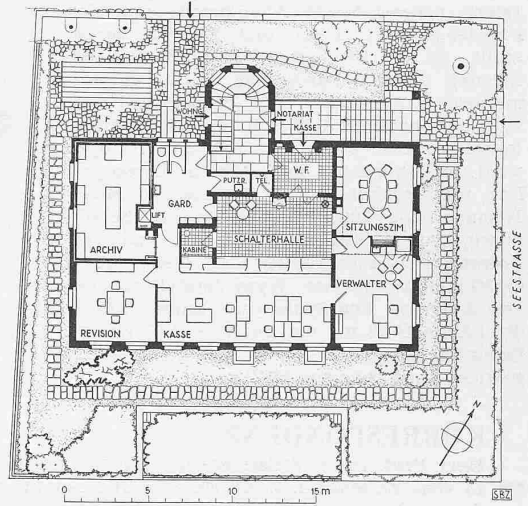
Lageplan mit Erdgeschoss-Grundriss, 1 : 400
